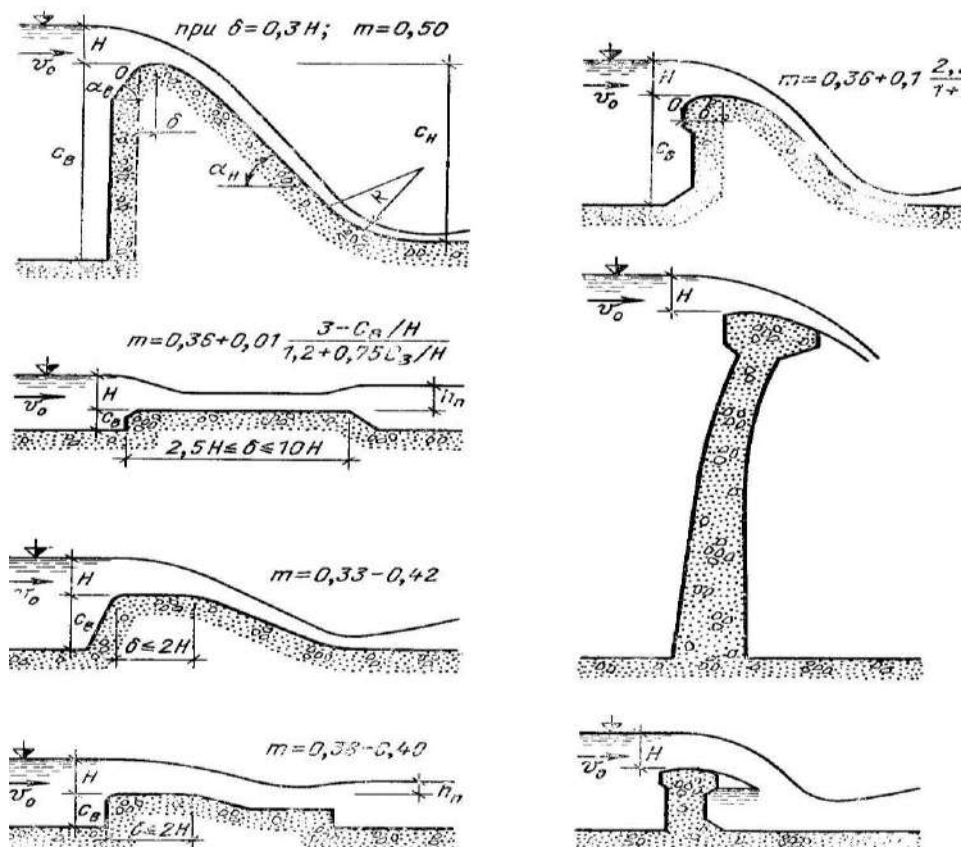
Водосливы (堰 · 溢流堰 · 溢水堰 ; 溢洪道) и значение их коэффициента расхода m для бетонных плотин
